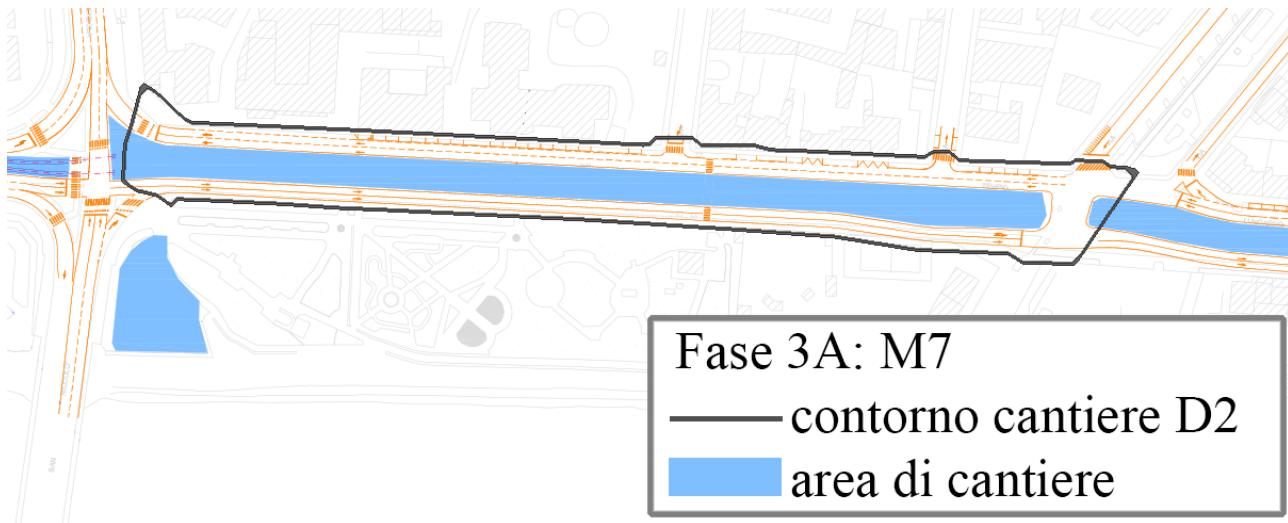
Fase 3A del cantiere D2 - viabilità ai lati dell'area di cantiere con due corsie per senso di marcia - cantiere centrale
